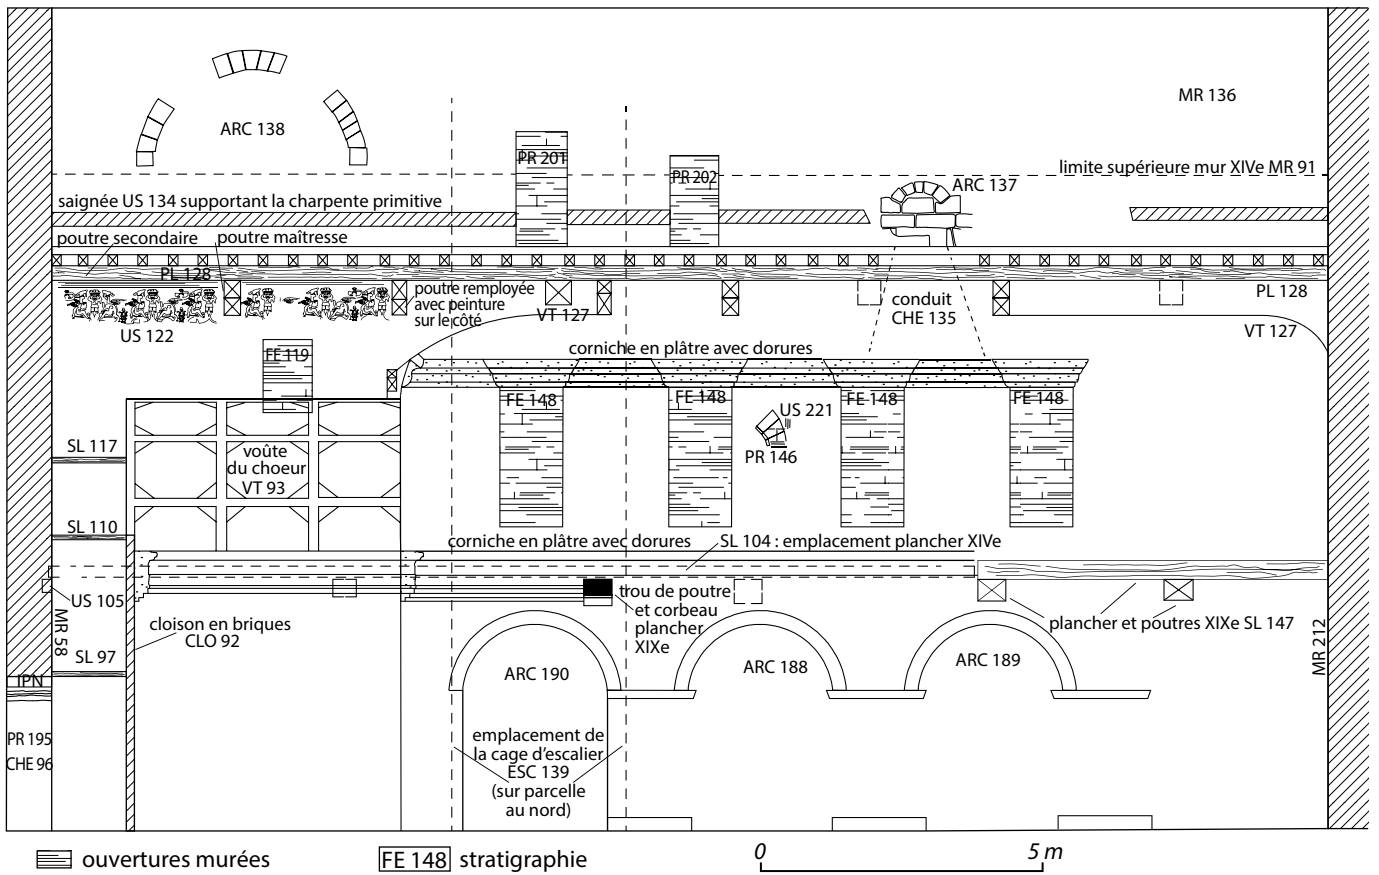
AVIGNON, hôtel du roi René. Grand tinel/chapelle ; face nord : coupe ouest-est (DAO G. Baro / SADV).
